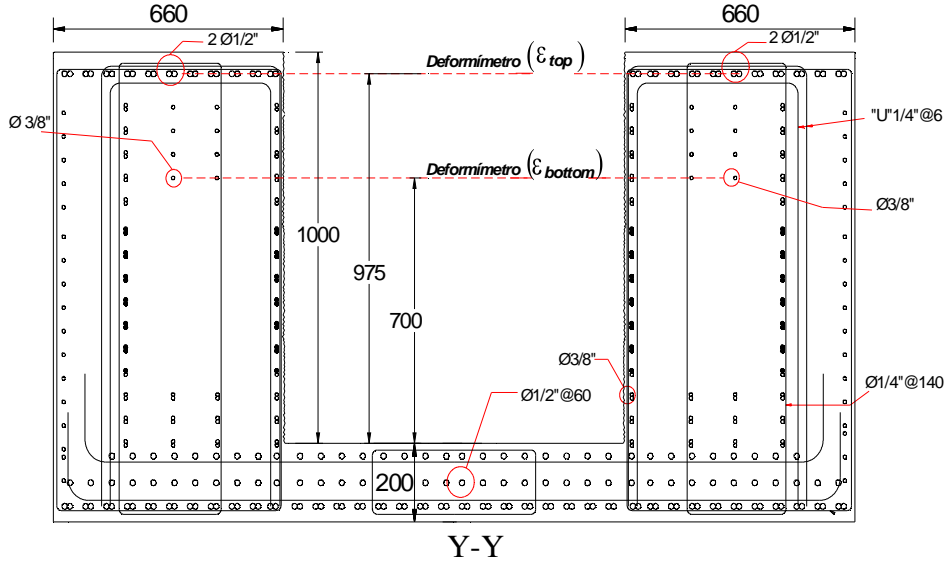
Sección transversal Y-Y de la cimentación tipo candelero
